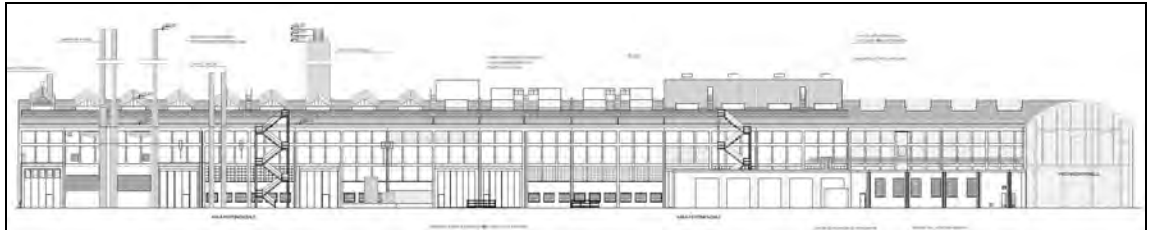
Estratto tav 01 – Prospetto est (stato di fatto)
